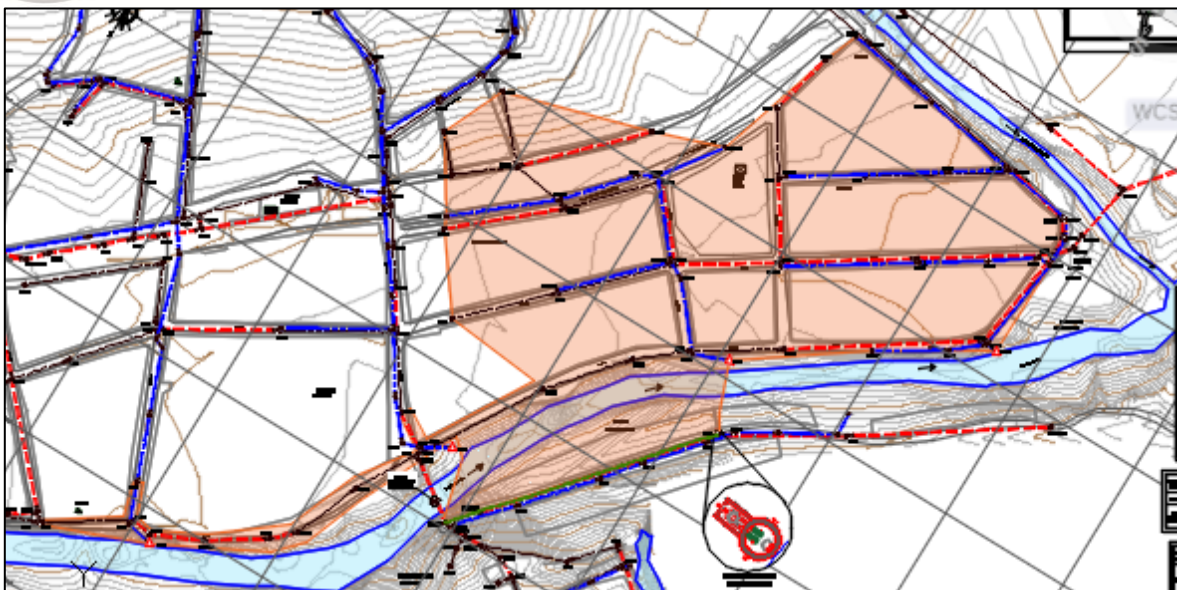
Delimitación de alcance Plan maestro de alcantarillado Villeta Fase 1.
